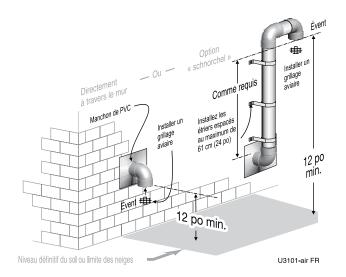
Entrée d'air dans mur latéral (terminaison) pour évent direct : évent vertical/air sur mur latéral
